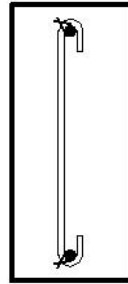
Схема армування перерізу балки плоским каркасом
